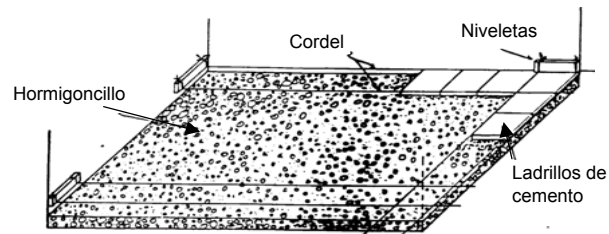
Proceso constructivo de piso de ladrillo de cemento
